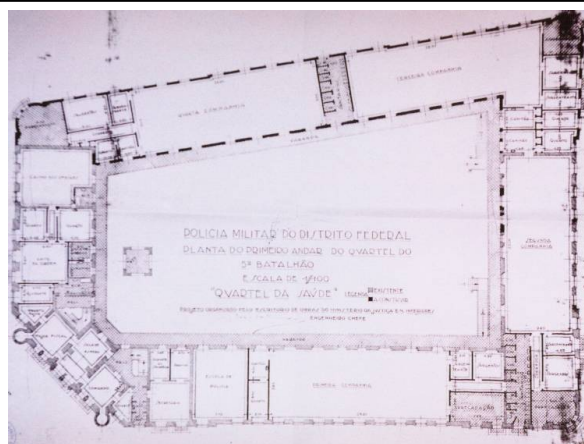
Planta baixa Batalhão da Saúde primeiro pavimento.
